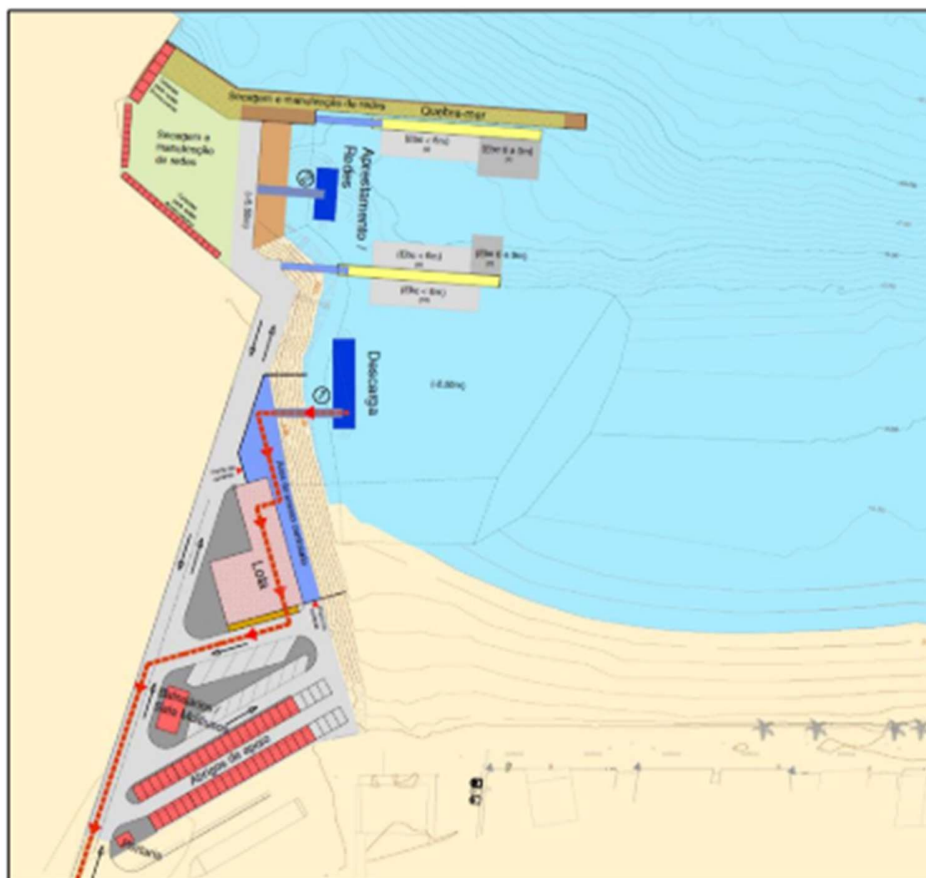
Solução Final - Alternativa 4 revista (Fase 2) – Implantação Geral
